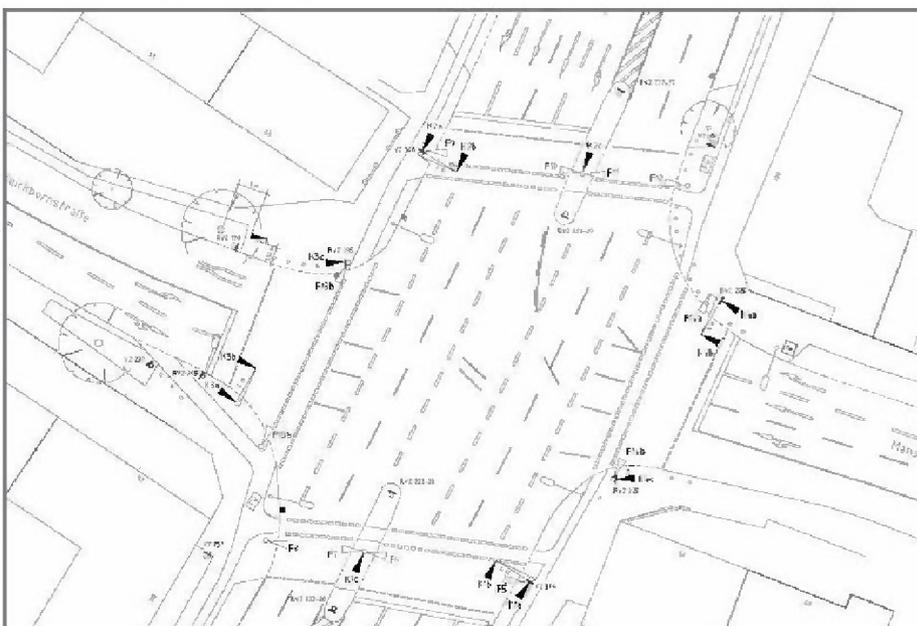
1 Signallageplanausschnitt der LSA 504
